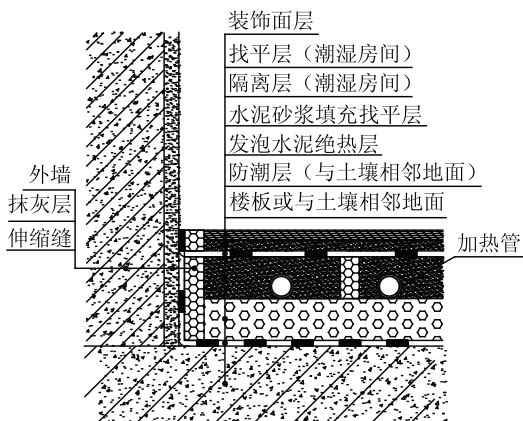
混凝土填充式热水供暖地面构造（二）
